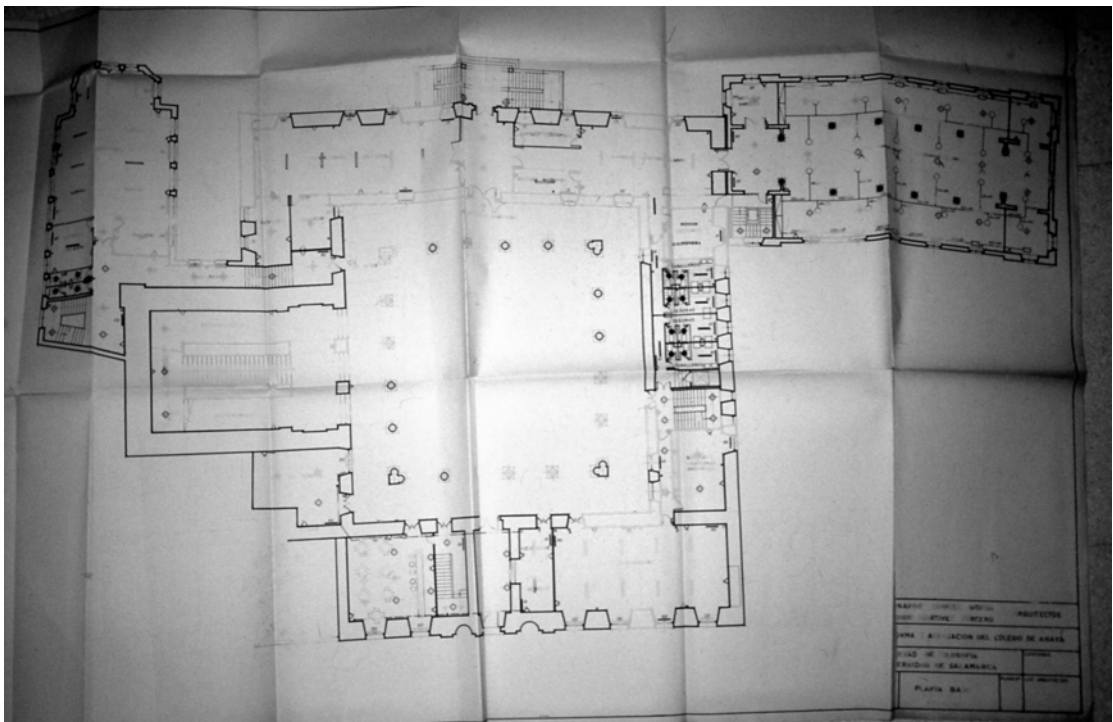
Palacio de Anaya: planta baja, por F. Chueca y E. Martínez, 1969.
